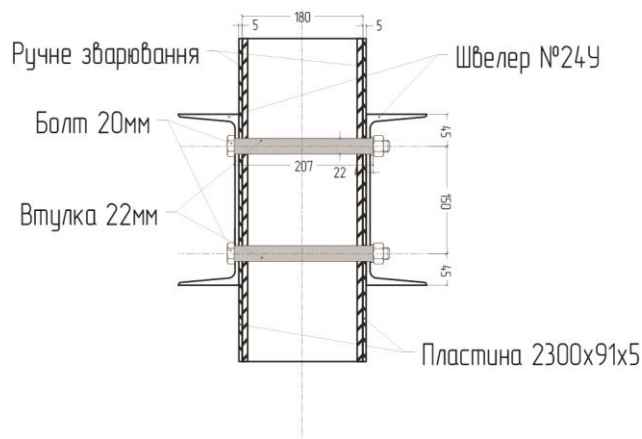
З'єднання силової рамної установки з вертикальними опорами
